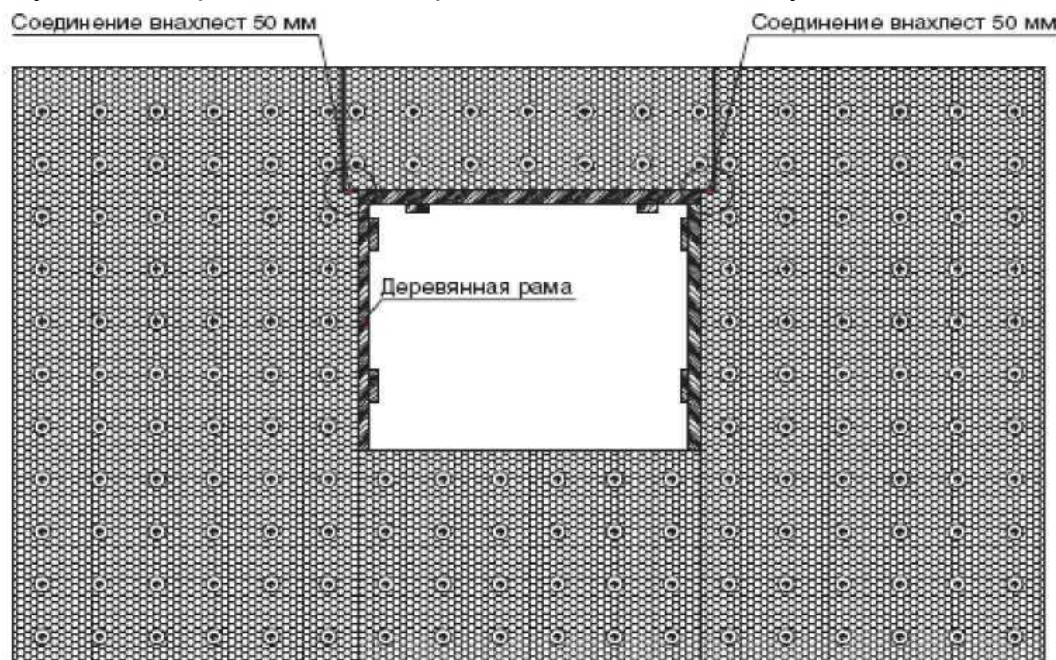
Создание проема в элементах стеновой опалубки.
